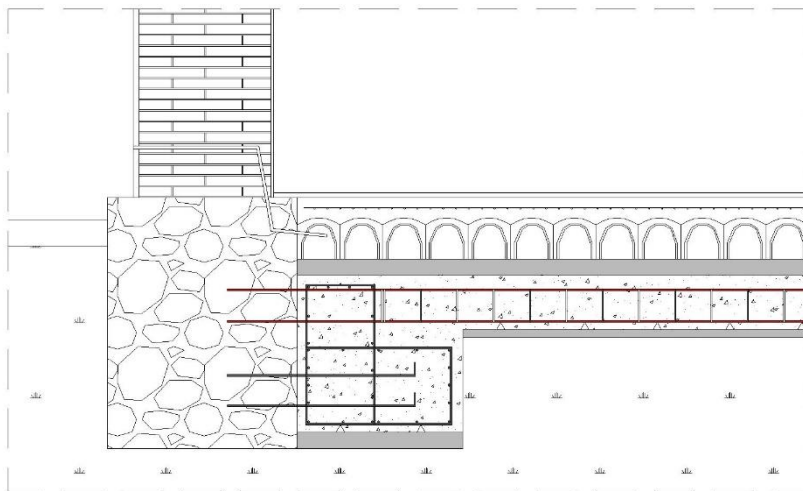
Refuerzo cimentación fachada. 2015. Fuente propia.
